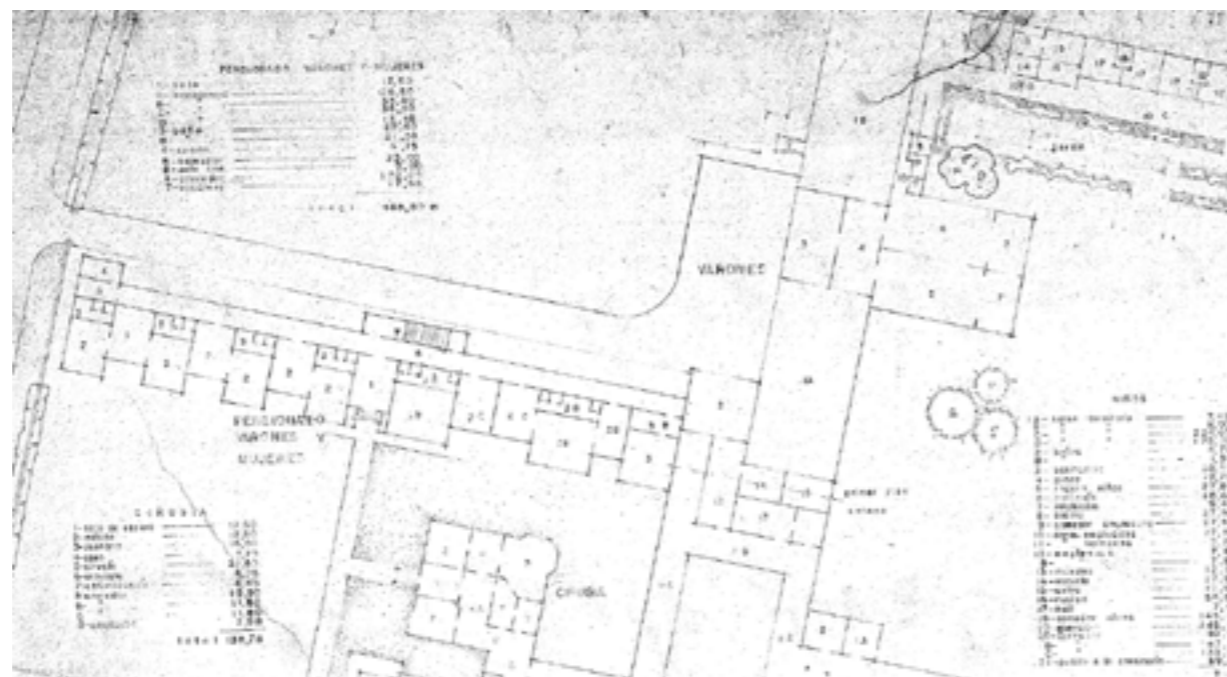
Levantamiento de edificios de Cinemateca y Pabellón de hombres del Sanatorio.
